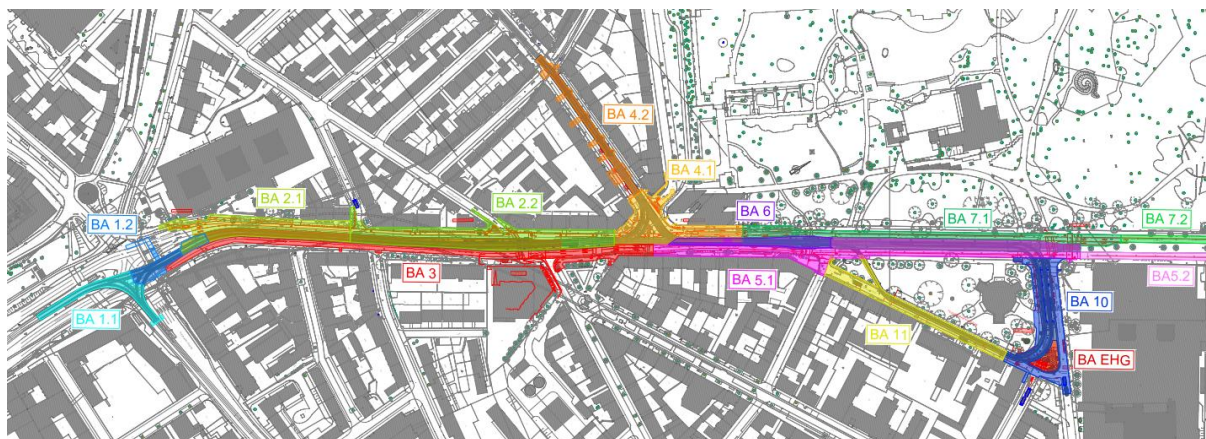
Bauphasenplan (Unterlage 16.2)
